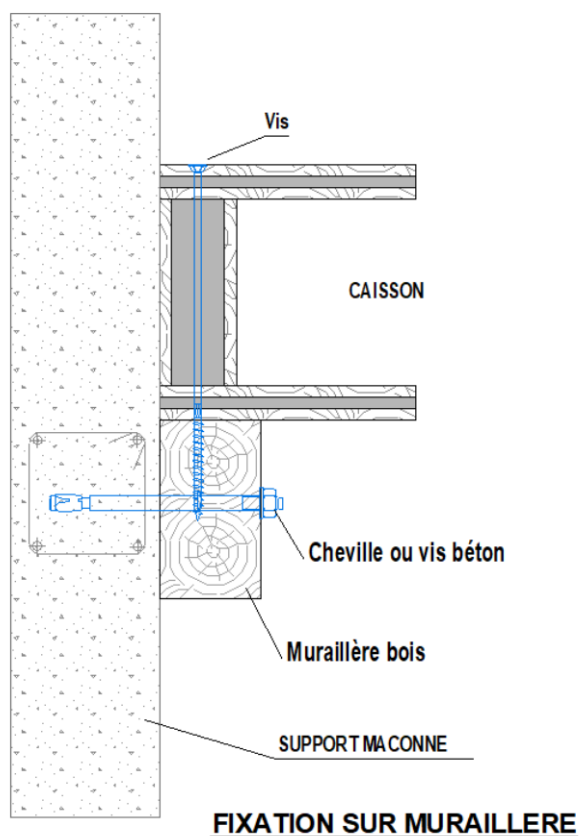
Fixation sur muraille (non applicable en situation sismique)
